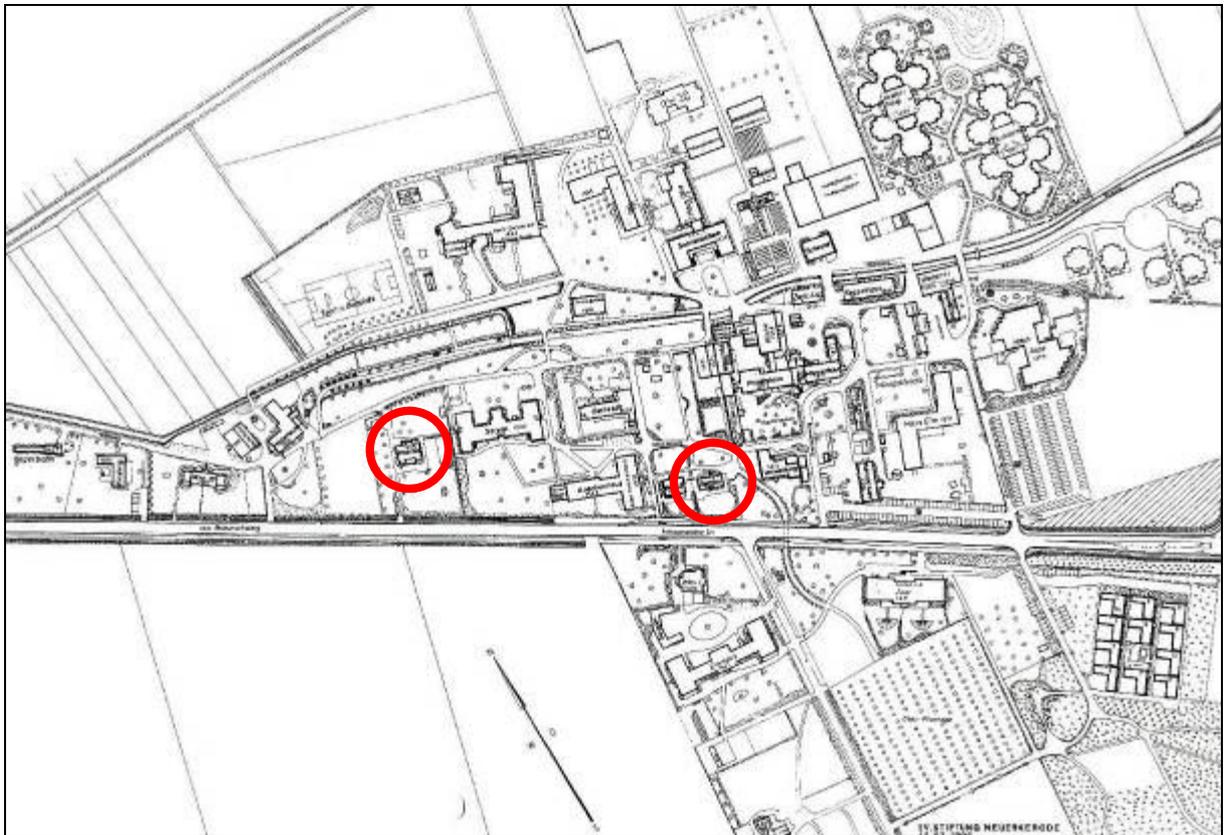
Standort Dachsanierung Bethanien und Pfarrhaus
